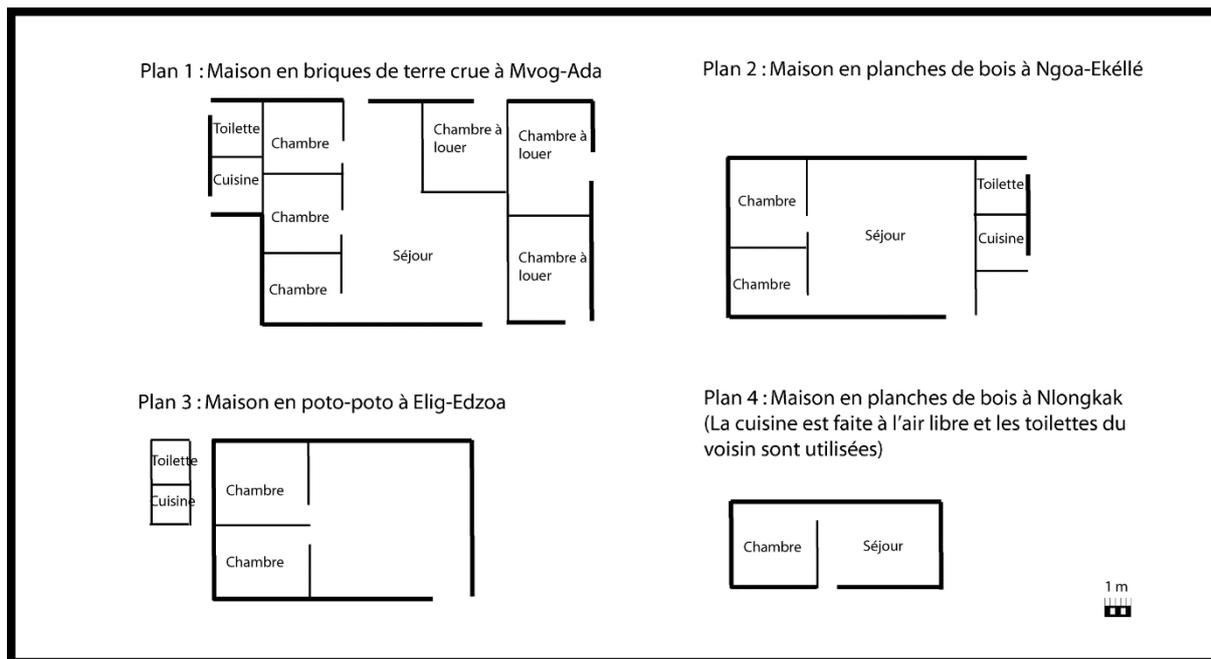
Plans des maisons construites sur des parcelles de terrain occupées de façon précaire
